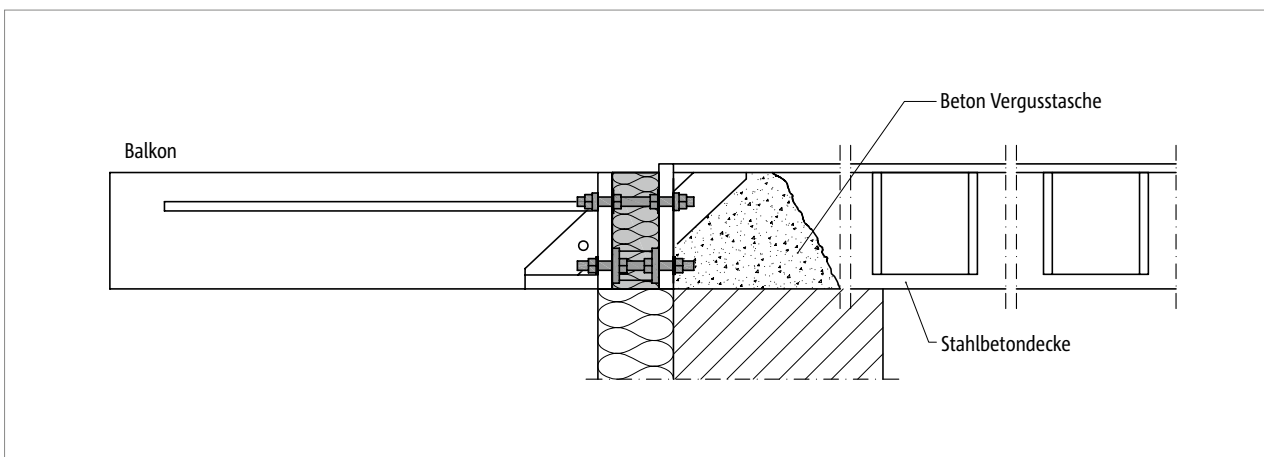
Schöck Isokorb® T Typ S: Nachträglicher Ortbetonbalkon frei ausragend; mit Zugband an bestehende Stahlbetondecke
